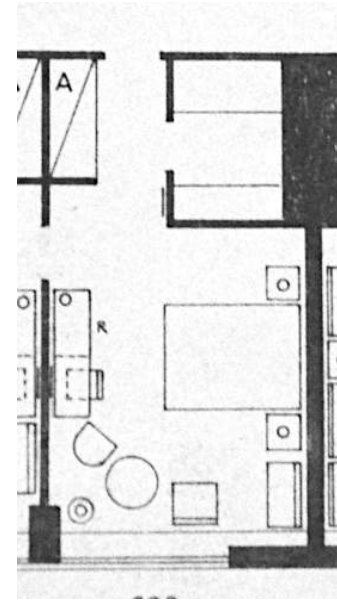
Grundriss Zimmertyp „Doppelbett“
